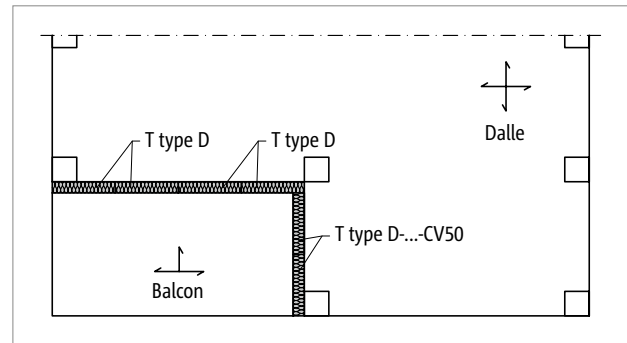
Schöck Isokorb® T Type D : Utilisation dans des planchers plats
